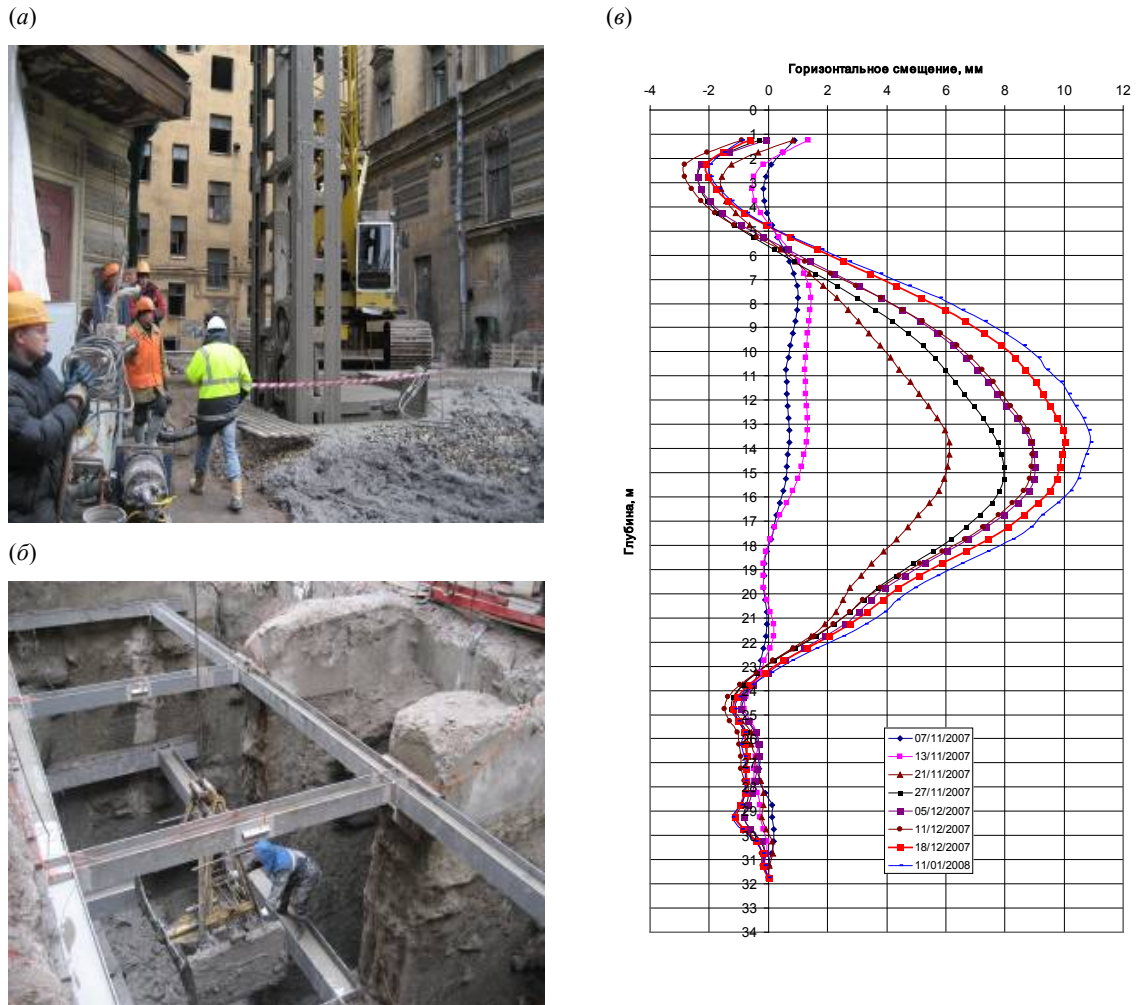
Опытная площадка (Санкт-Петербург, Зоологический пер., д. 2–4) : (а) – изготовление «стены в грунте»; (б) – вид после откопки котлована; (в) – горизонтальные смещения массива грунта (со стороны здания) при устройстве стены в грунте по результатам инклинометрических наблюдений
